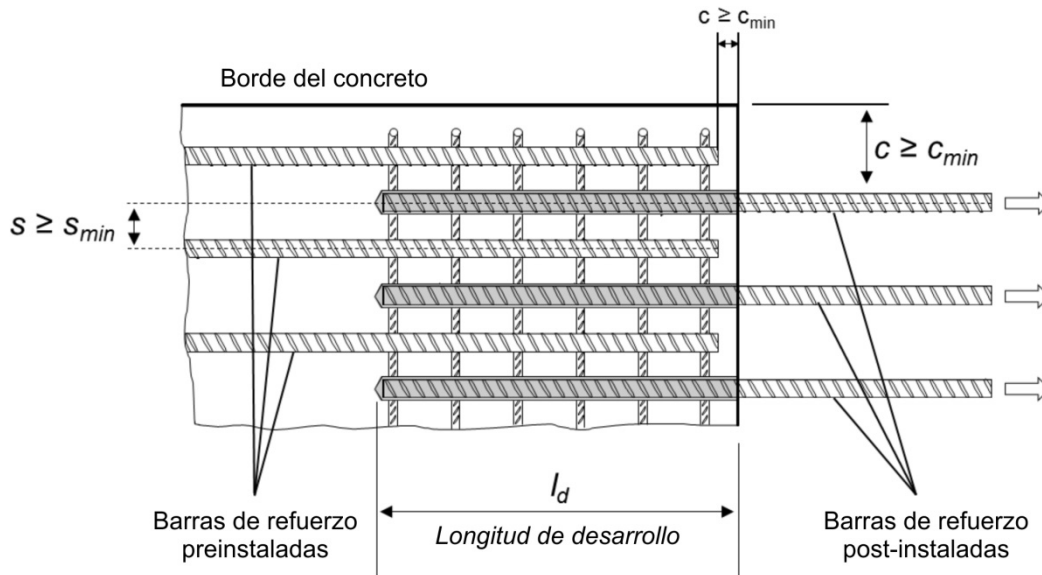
PARÁMETROS DE INSTALACIÓN PARA BARRAS DE REFUERZO POST-INSTALADAS
